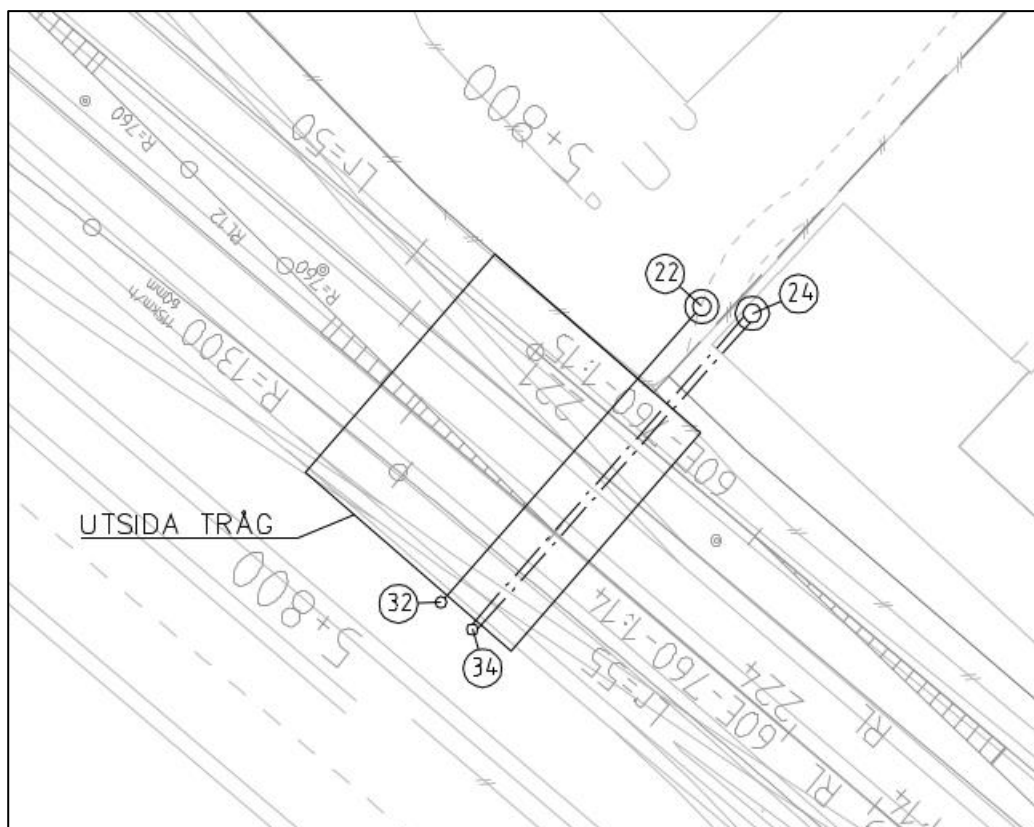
Sekvens som visar byggande av norra tunnelröret Sundbybergstunneln.
